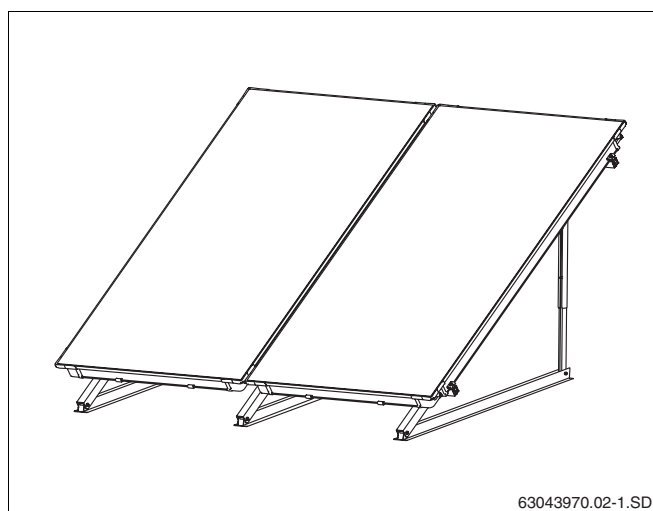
Imagem geral do conjunto de colectores, montagem em telhado plano
